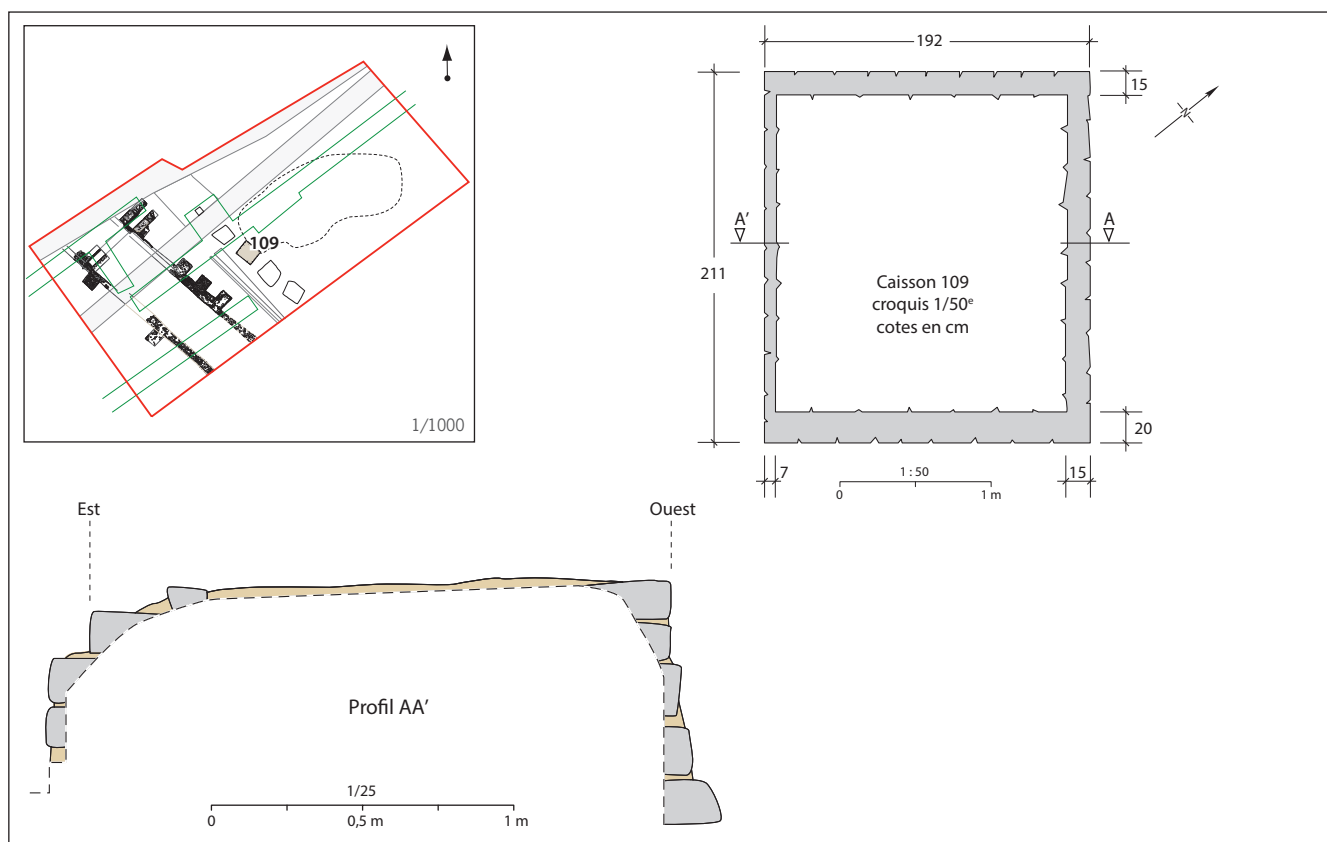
Plan et profil de la pile 109 (dessin C. Gaston, DAO F. Bergantz).
